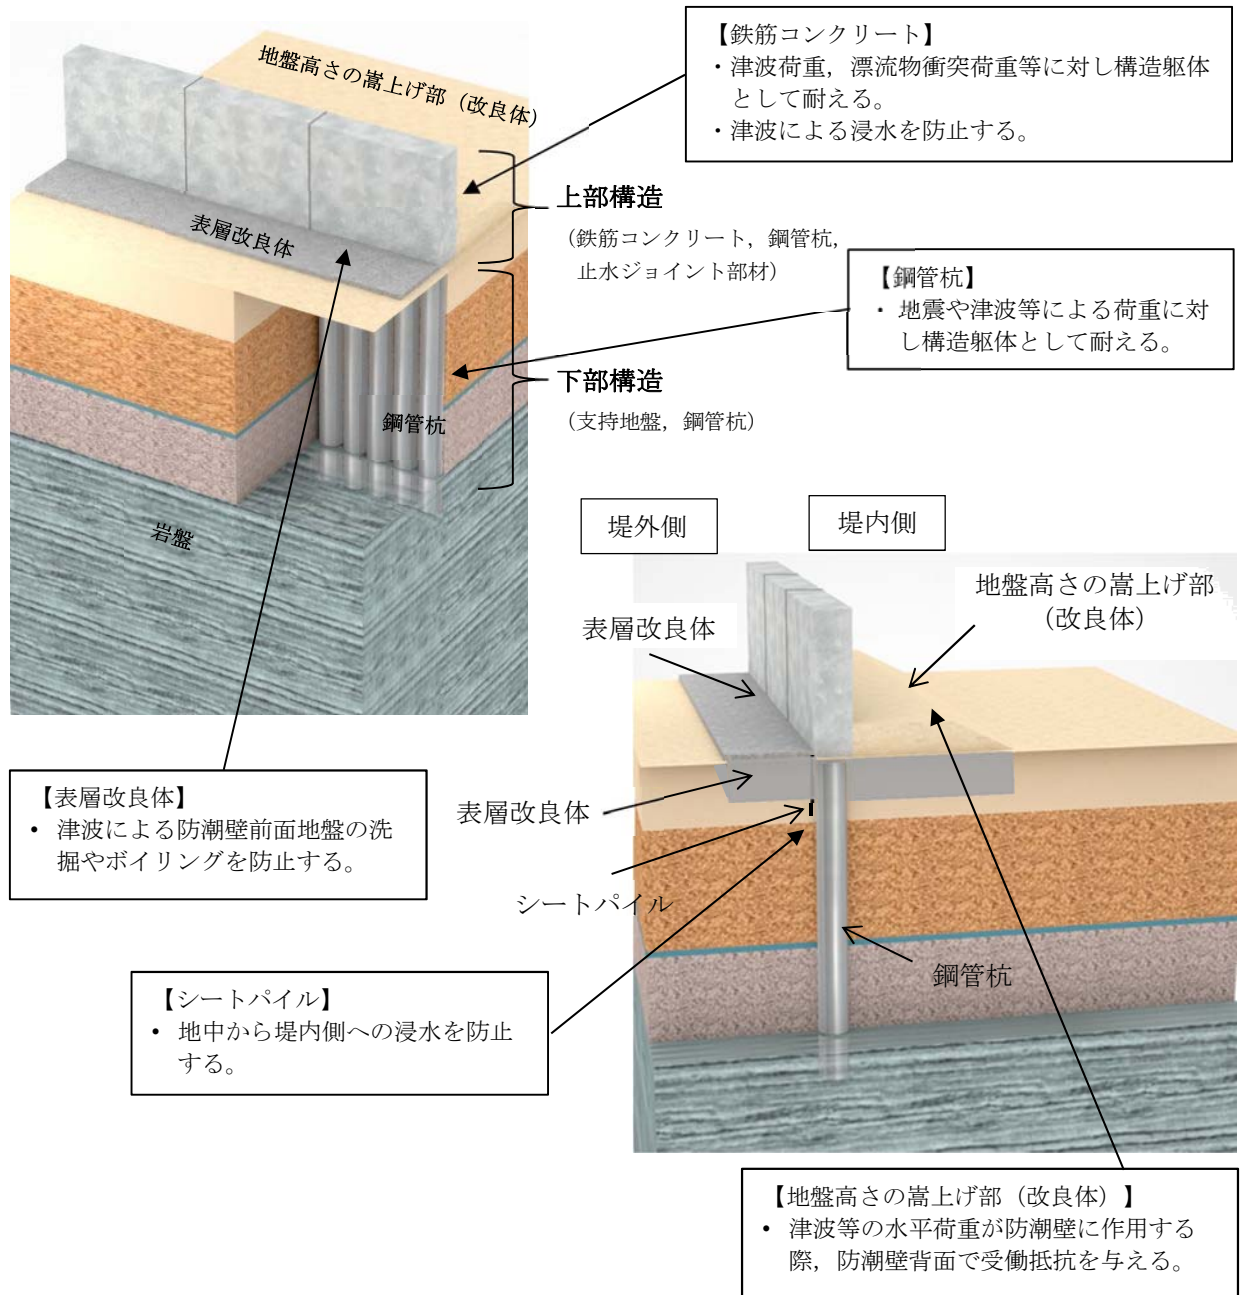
(2) 鋼管杭鉄筋コンクリート防潮壁の構造概要図
